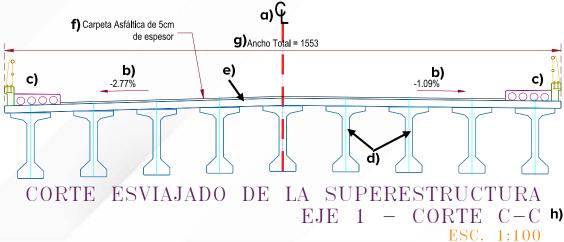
Ejemplo de corte C-C, esviajado de la superestructura, eje 1
